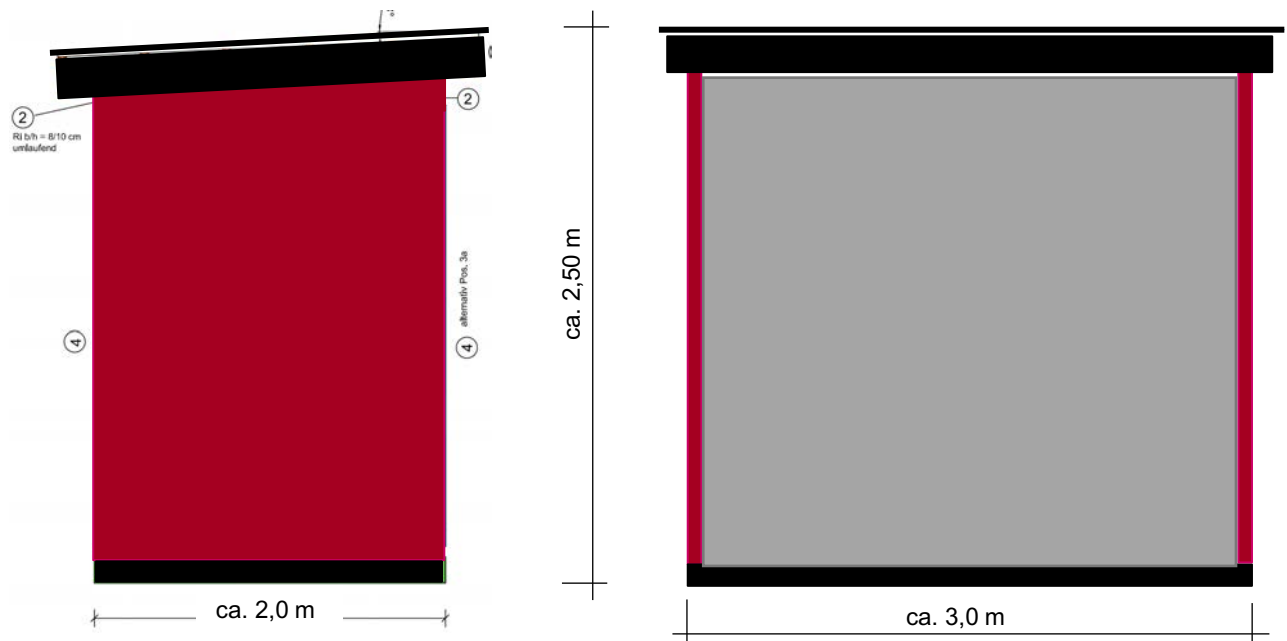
Demonstrator. Ansicht seitlich (links) und frontal (rechts).
